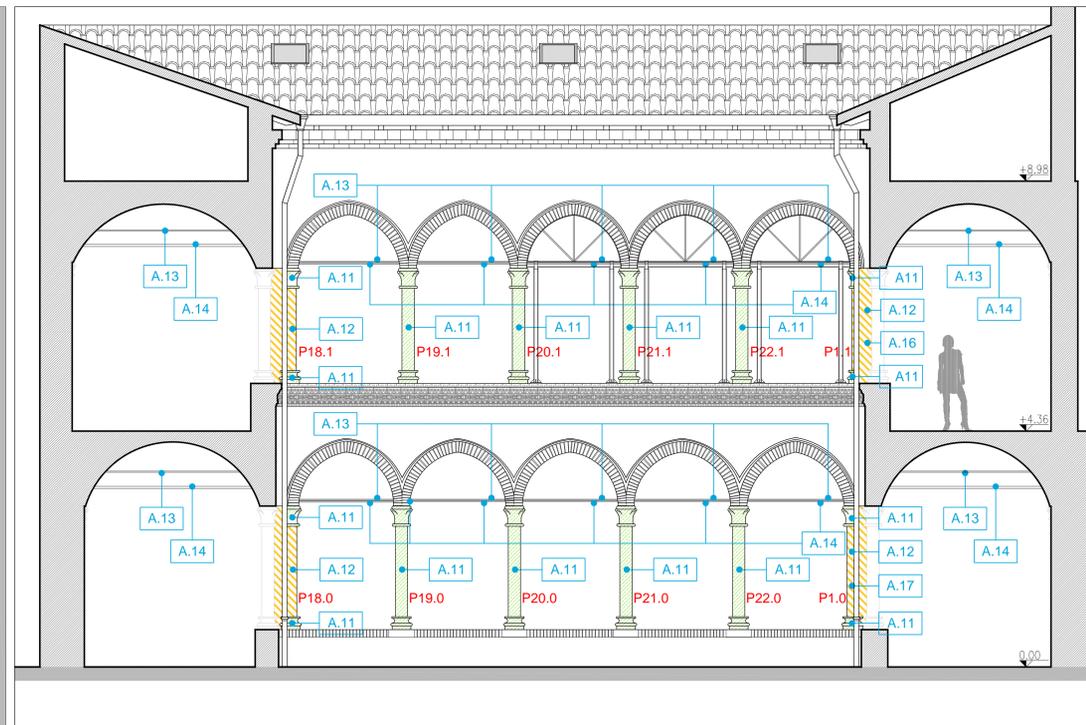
FOTOPIANO COLONNATO PROSPETTO SUD - Scala 1:50
